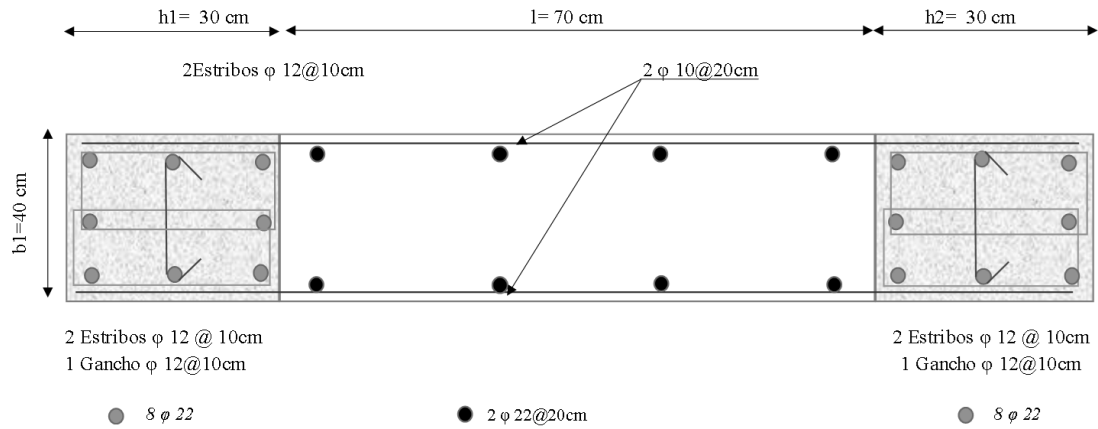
Armado del muro correspondiente a la geometría 1 en base al DDBD
